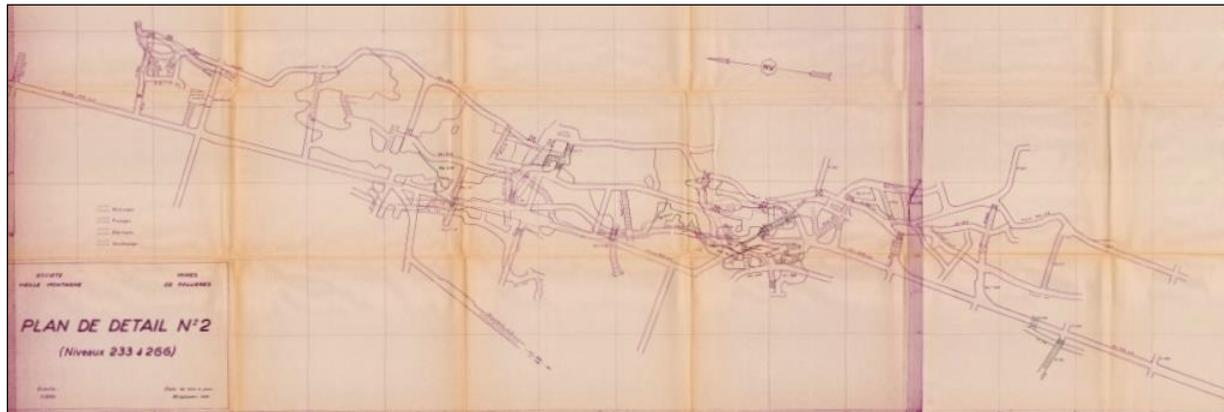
Mines de Pallières, plan de détail n° 2 (niveaux 233 à 266) (1956)
